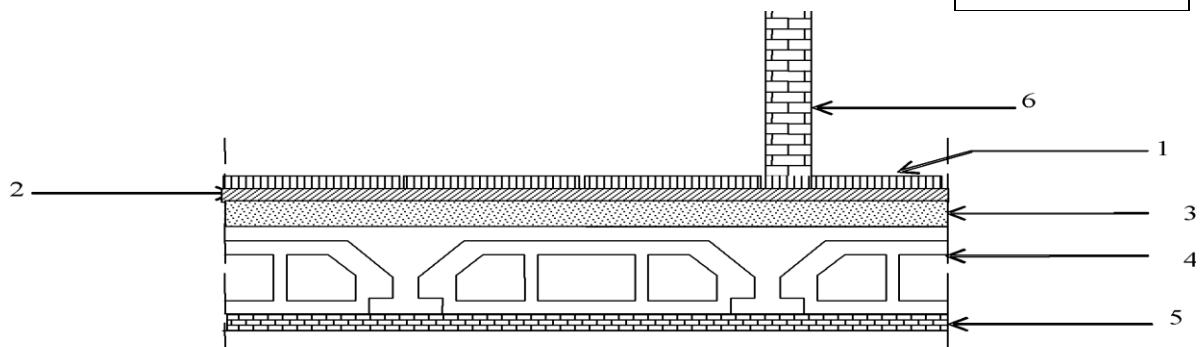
Coupe transversale au niveau de plancher étage courant.
